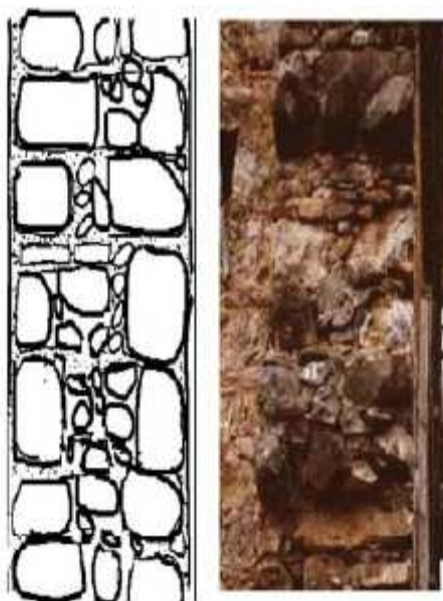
Ps: sezione muraria a doppio paramento (paramenti non collegati)
